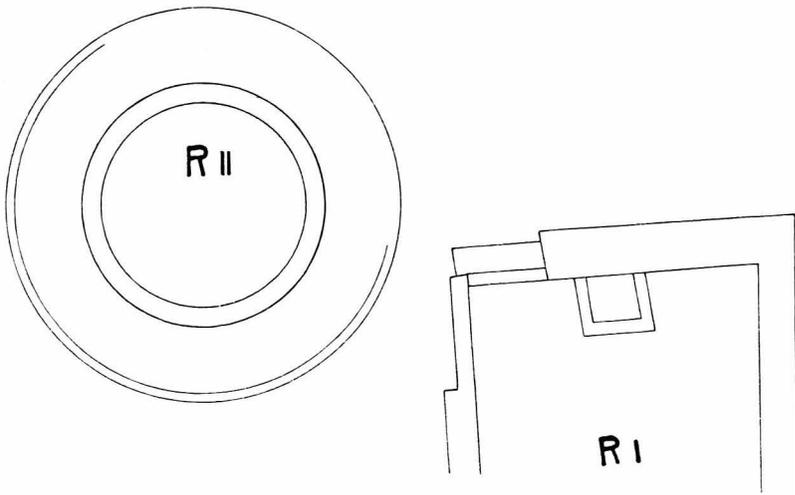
Plan der Burg Kindhausen. Ca. 1 : 25
